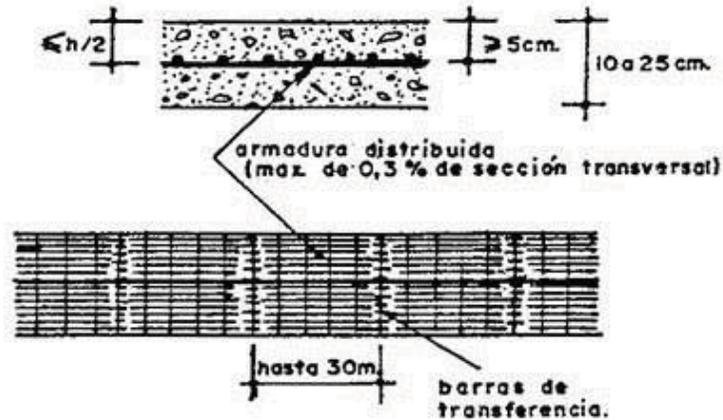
Estructura de un pavimento rígido reforzado con acero estructural.
